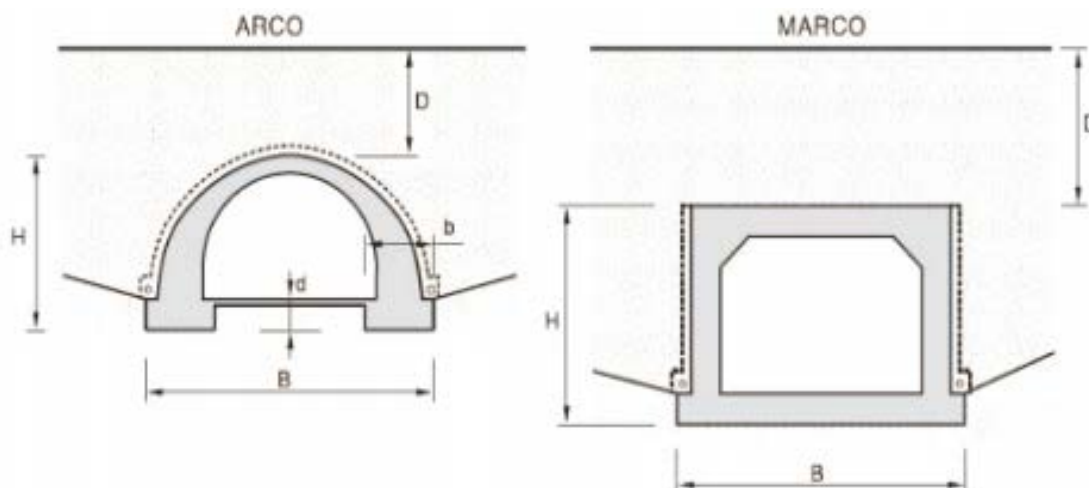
Esquema de los pasos tipo bóveda y marco. (Fuente: Guía de cimentaciones en obras de carretera. Ministerio de Fomento 2009).
